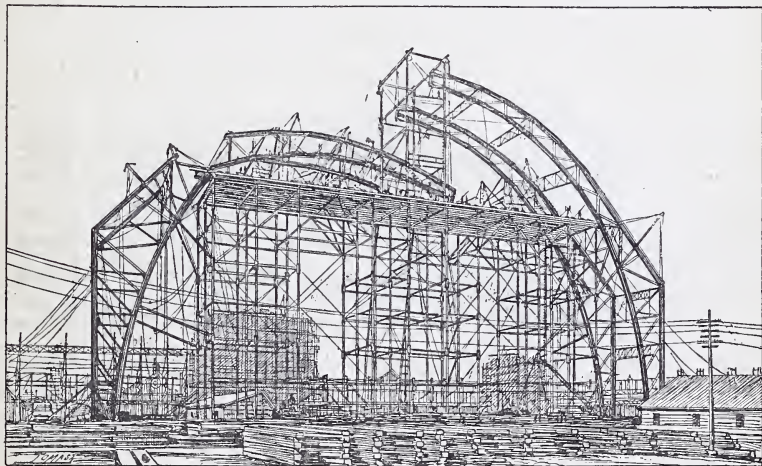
Exposition de Chicago. — Palais des manufactures et des arts libéraux.
